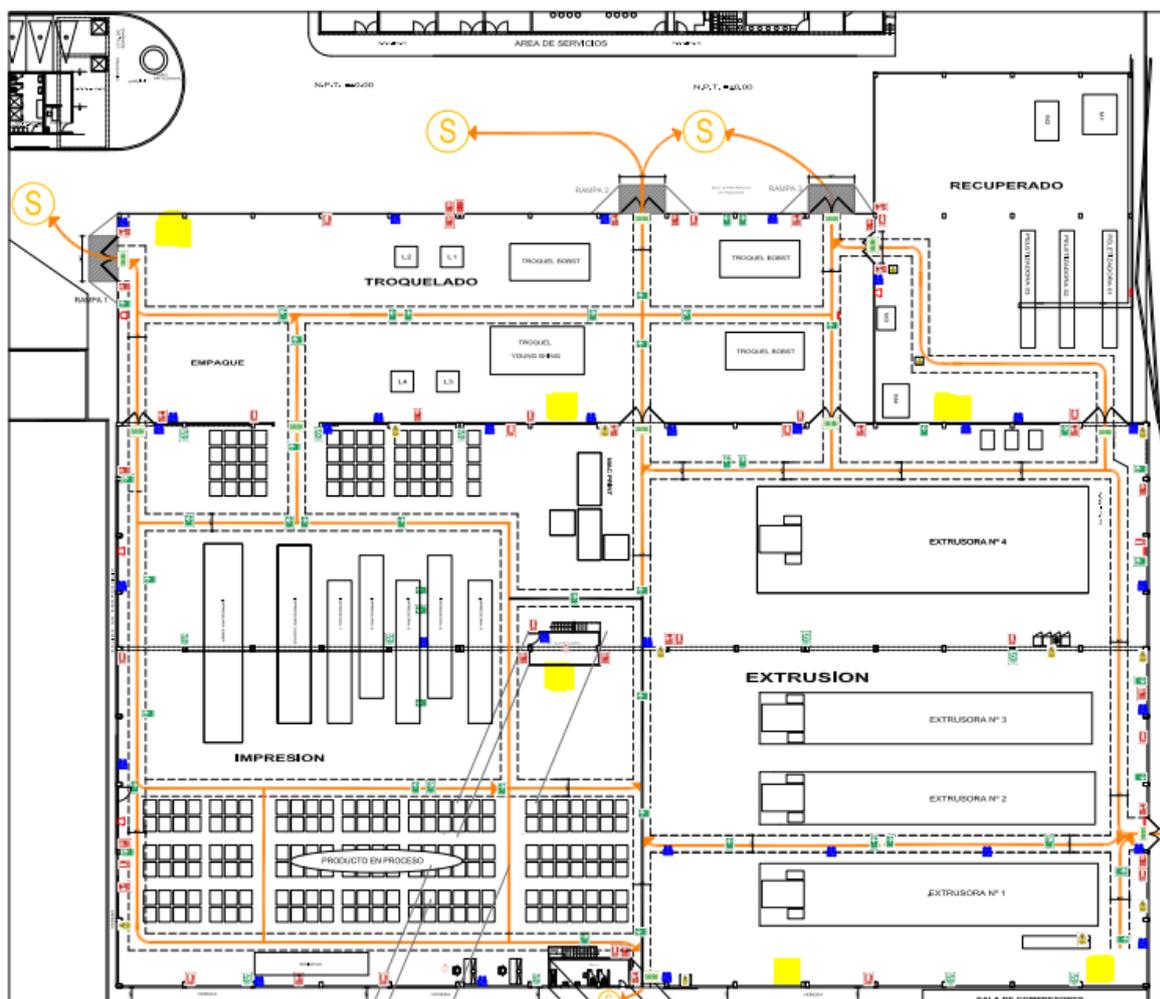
Plano de la planta con propuesta de puntos de red. Elaboración propia.
